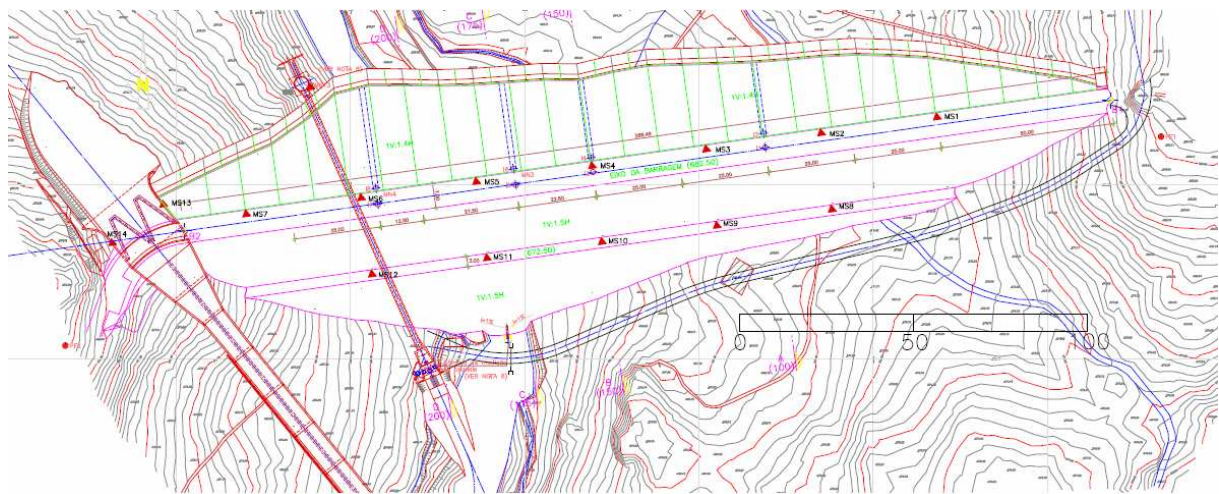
Planta da barragem do Pinhão com a localização dos equipamentos de observação
